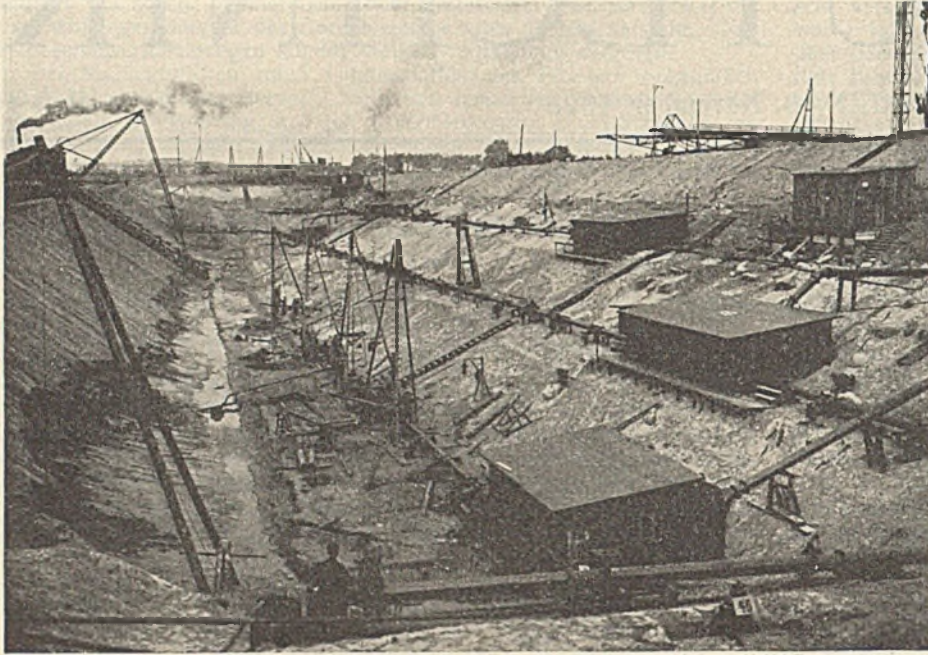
Aushub der Baugrube mittels Eimerbaggers. Staffel I zurückgebaut, Staffel II und III im Betrieb, Staffel IV beim Einbau.
